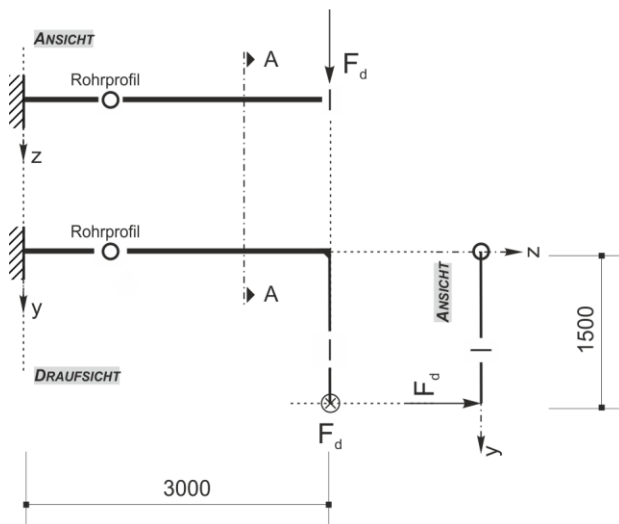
Statisches System mit Belastung, Abmessungen in Millimetern
